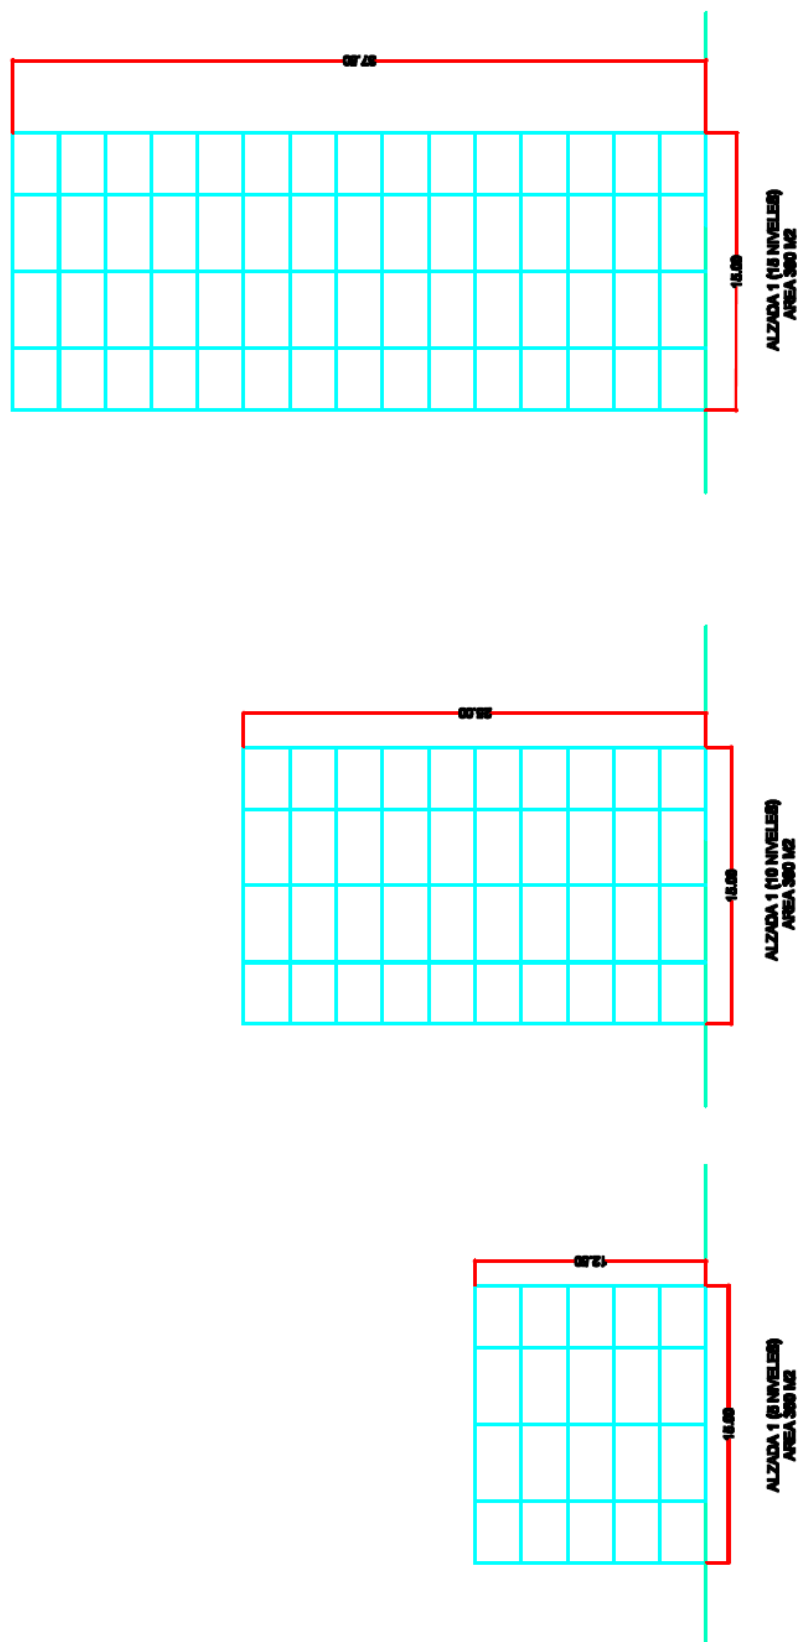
Figura II. Forma en alzado edificaciones 360 m<sup>2</sup>
